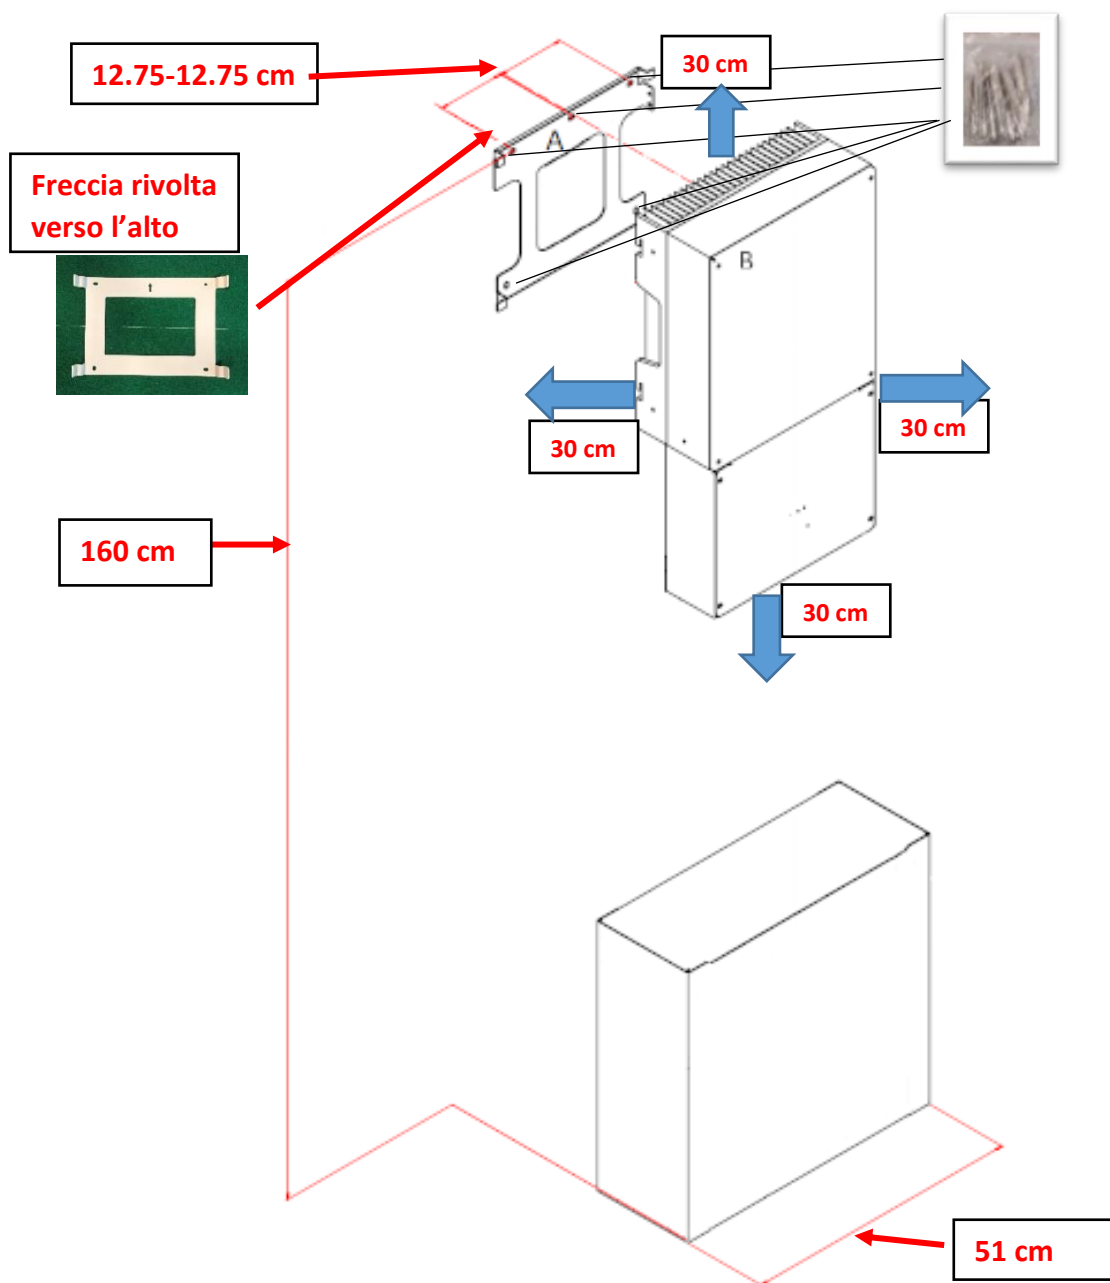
Distanza di fissaggio della staffa inverter dal piano
